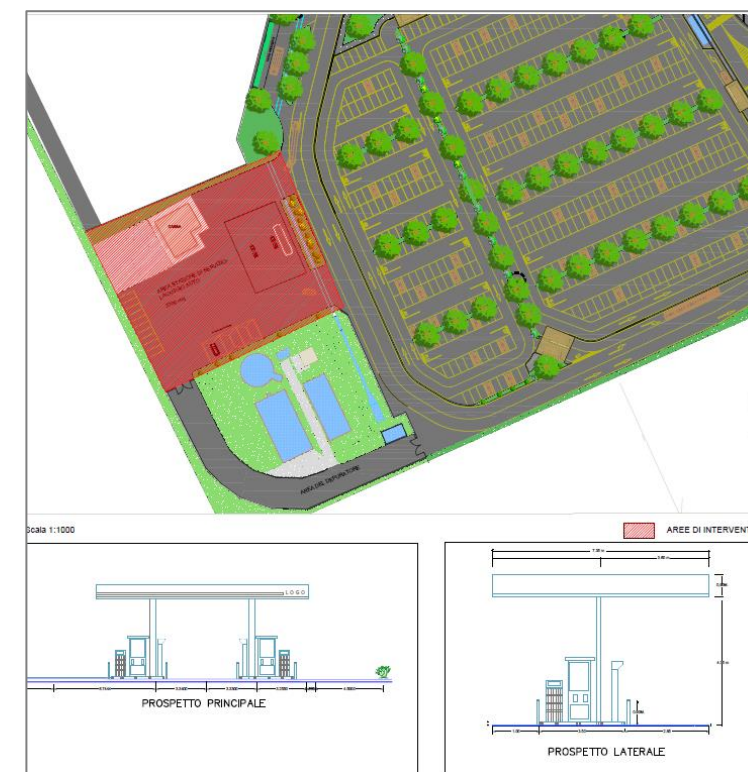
planimetria di intervento di realizzazione stazione di servizio
